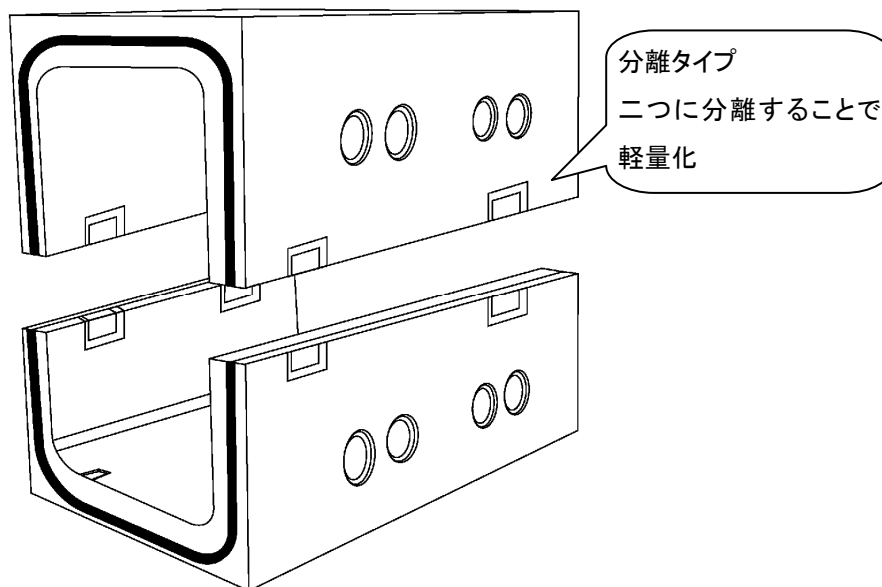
分割タイプの鉄筋コンクリート製特殊部
